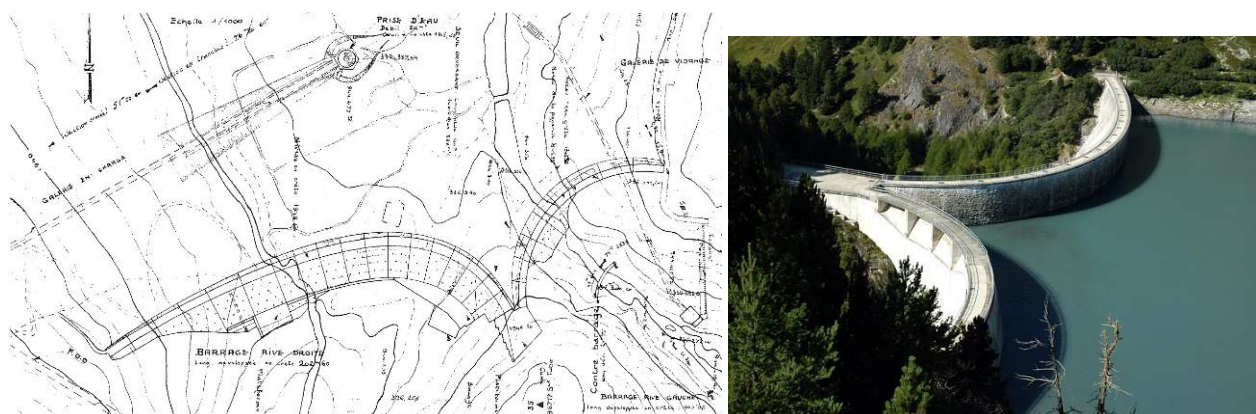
Vue en plan et vue amont de l'ouvrage de Plan d'Aval
